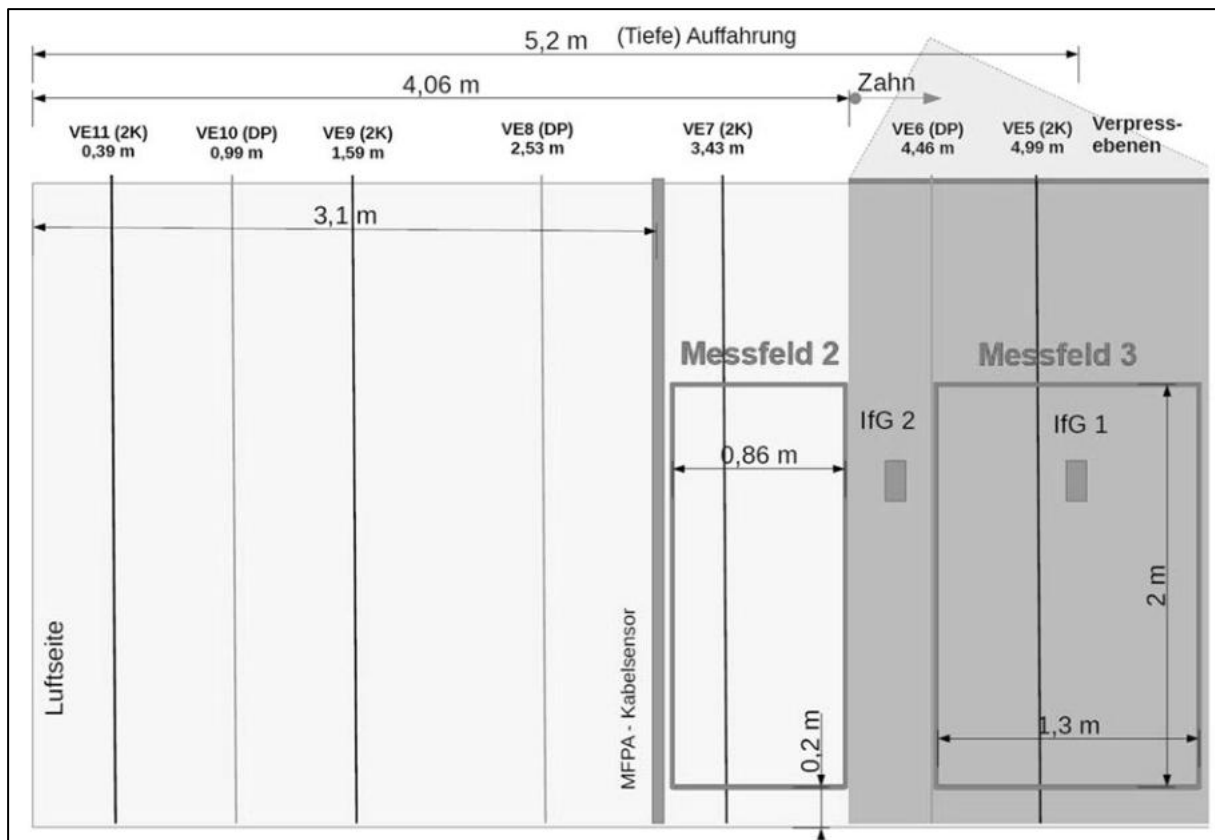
Seitenansicht der Ultraschallmessfelder der BAM an der rechten Mantelfläche des Bauwerkes GV2
